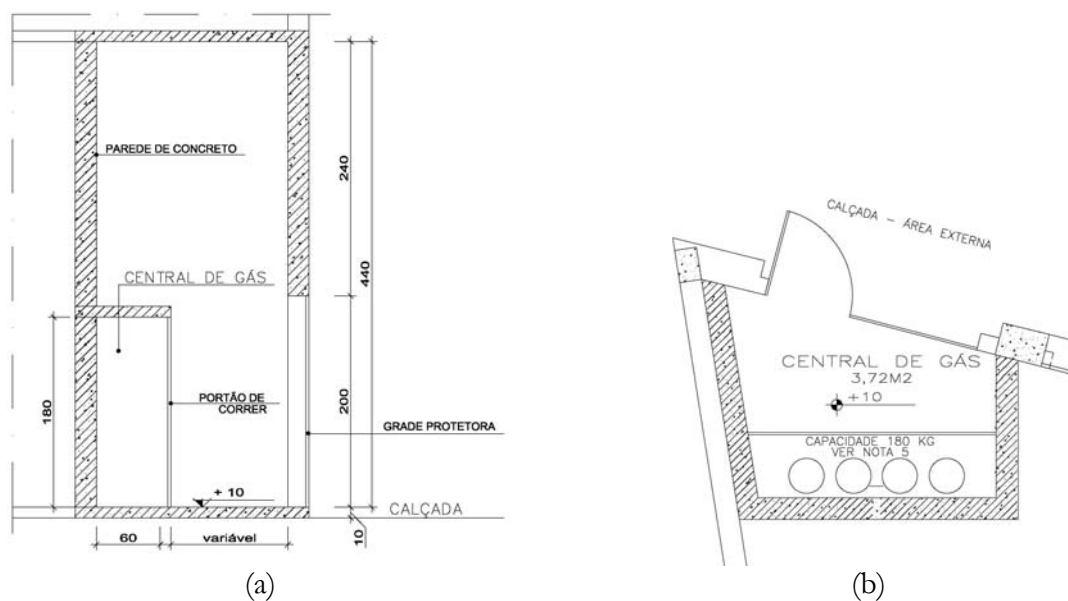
Detalhes do projeto da central de gás. (a) corte genérico; (b) planta baixa (Ed. Pouso Real)
